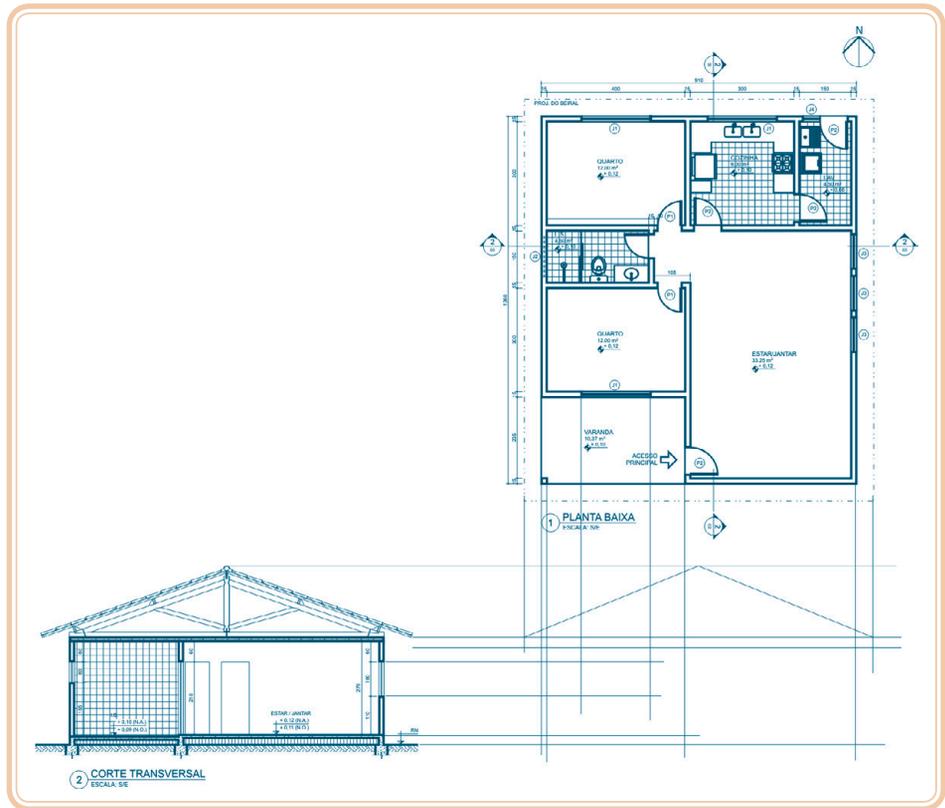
Desenho de uma fachada: obtêm-se as alturas do corte (linhas horizontais) e as larguras da planta (linhas verticais)
